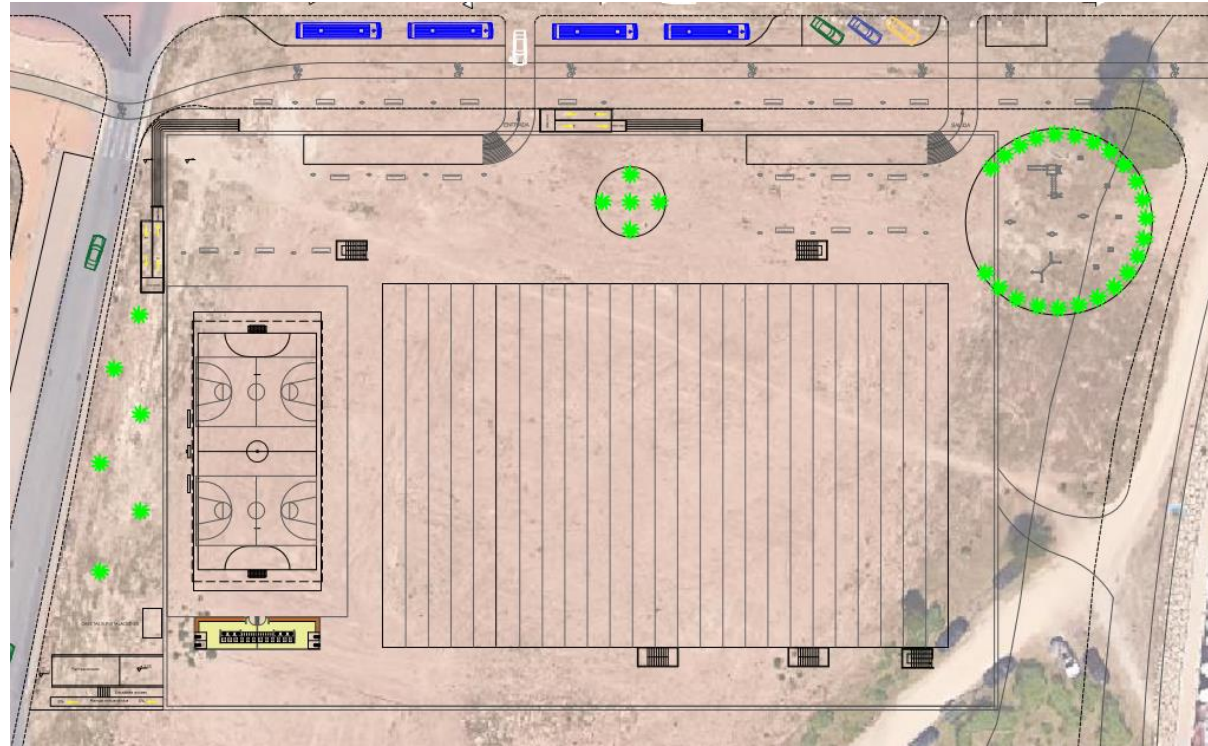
Situación en planta de la parcela. Fuente: Propia
